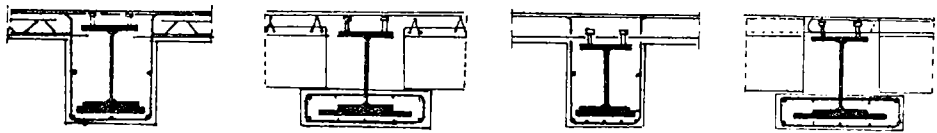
Planșeul este realizat din profile metalice secundare, peste care se betonează placa, adaptându-se conectori de legătură.
